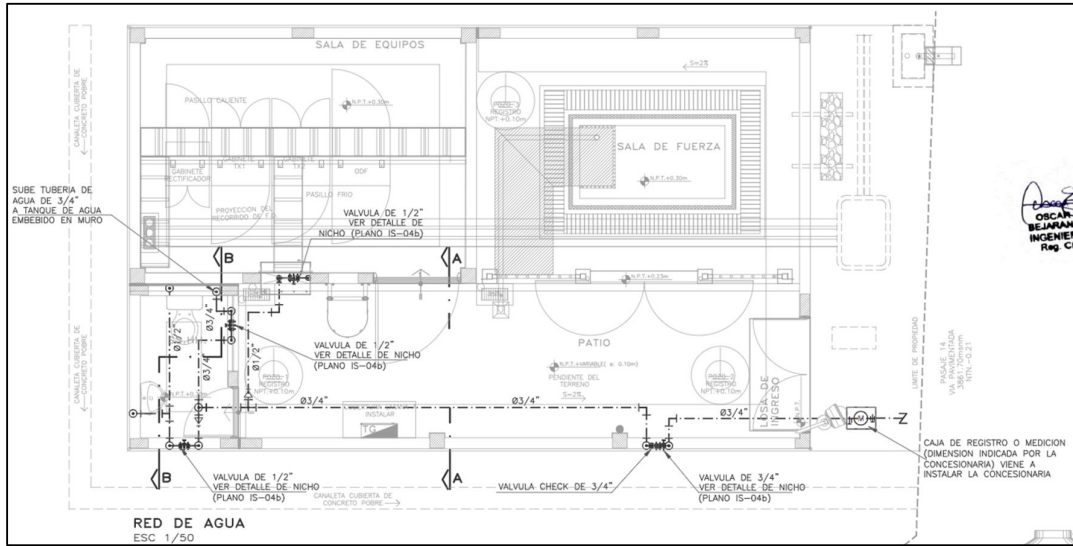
Plano de Planta de Red de Agua (IS-01)
